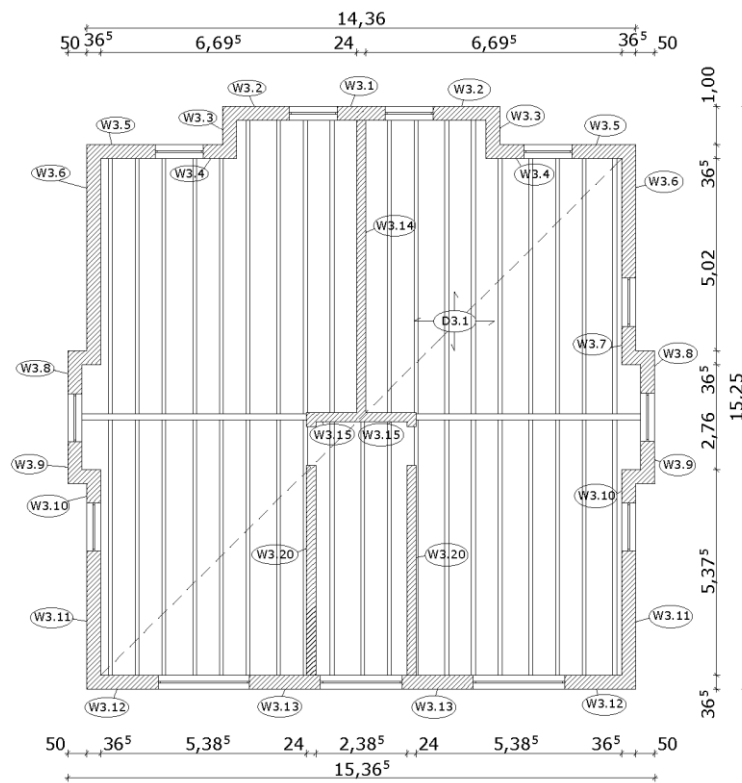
Grundriss des Dachgeschosses nach [2]
